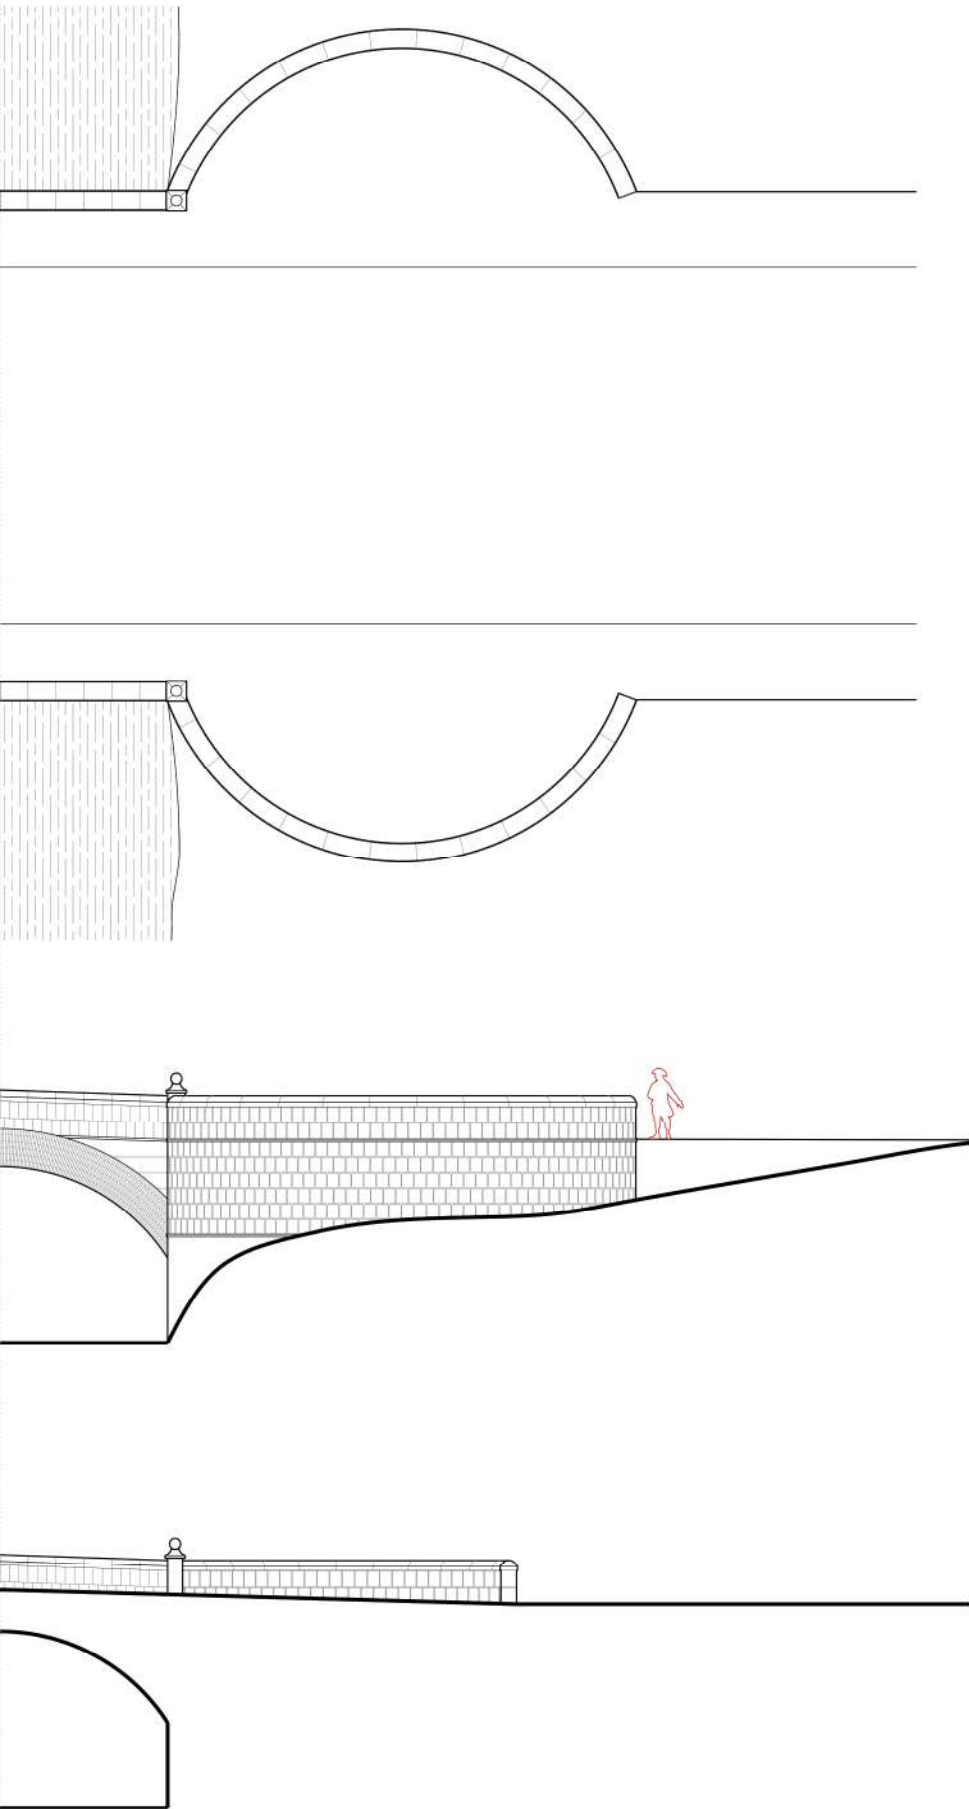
Planimetría general del Puente de Serrezuela, Madrid, Cundinamarca (Autor, 2024).
